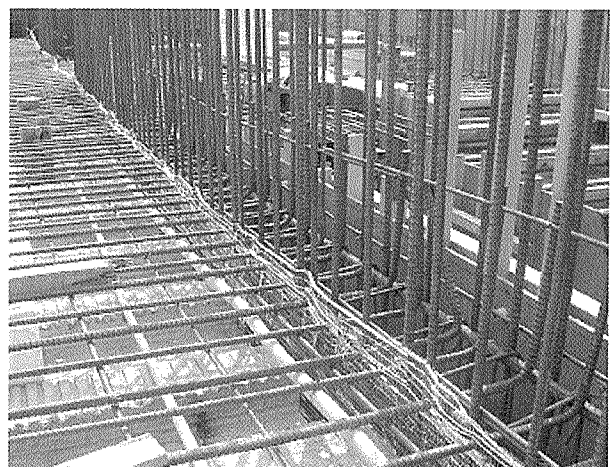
⑤ スラブ端部仕口ラス型枠区分
